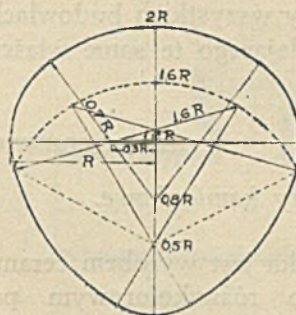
Przekrój głównego zbieracza w Lichtenberg.
